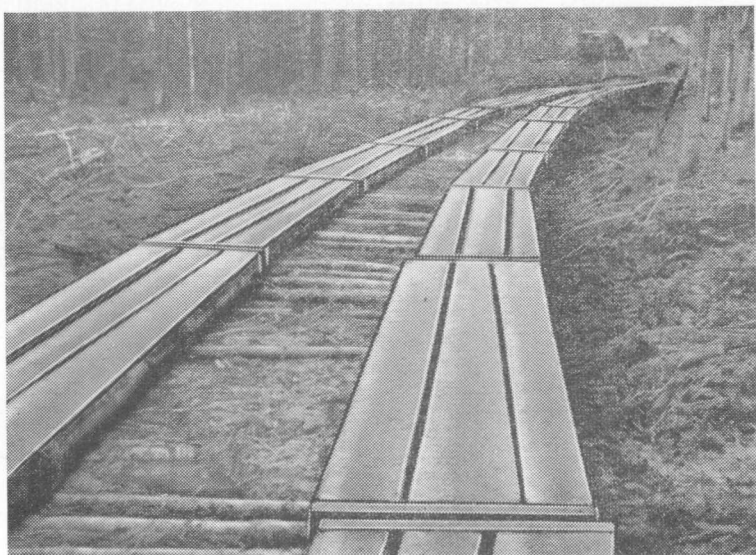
Общий вид уса с покрытием из деревянных щитов с металлическим креплением
